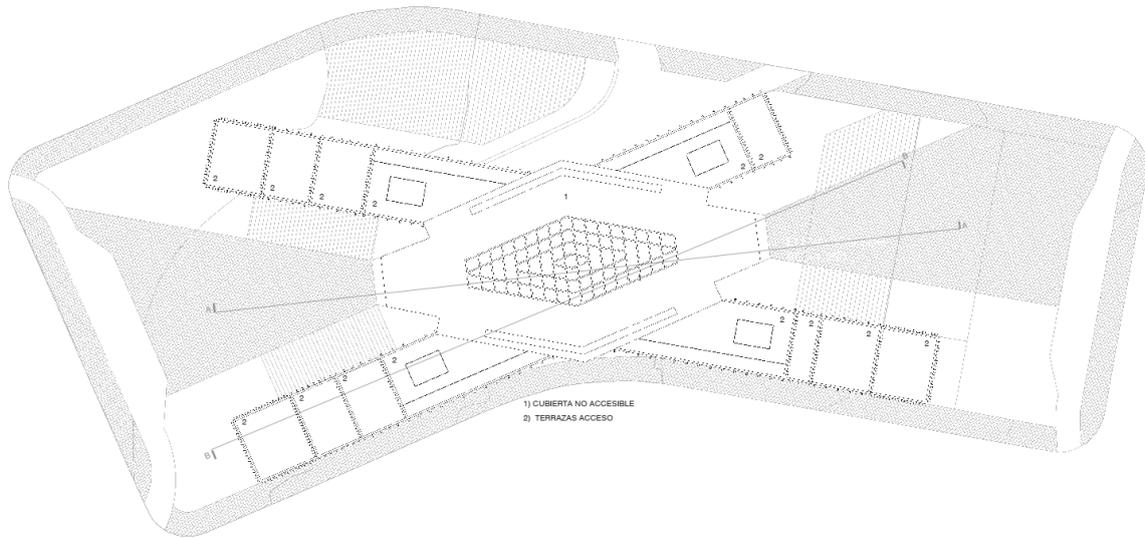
Planta PB + 14.00m. Elaboración propia
